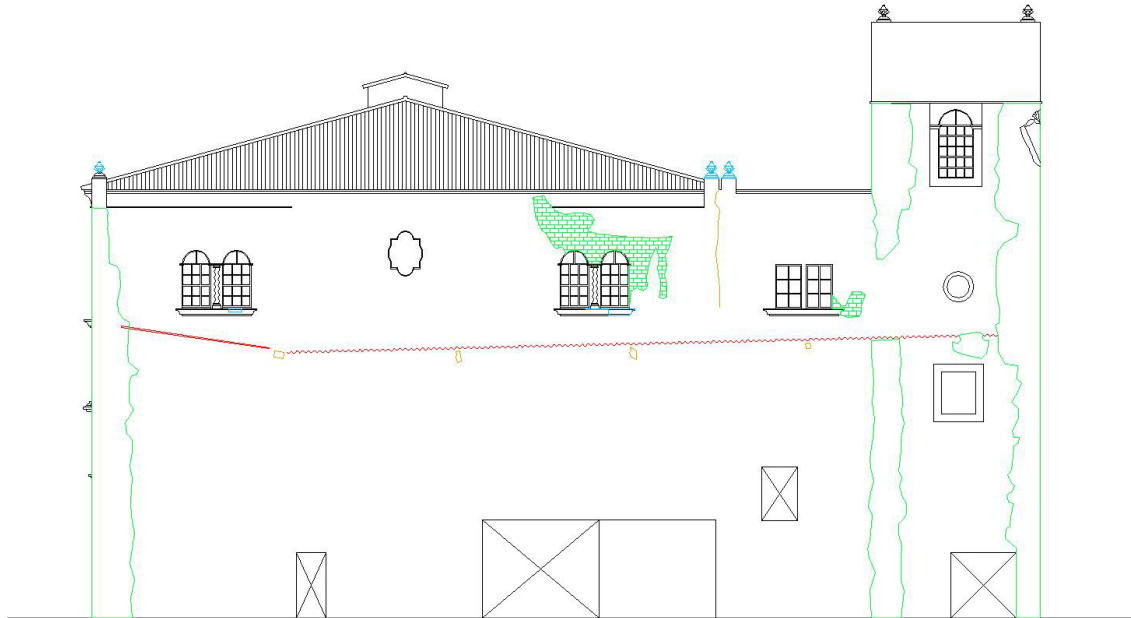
Alzado de la fachada Norte donde se muestra su cuadro patológico.
